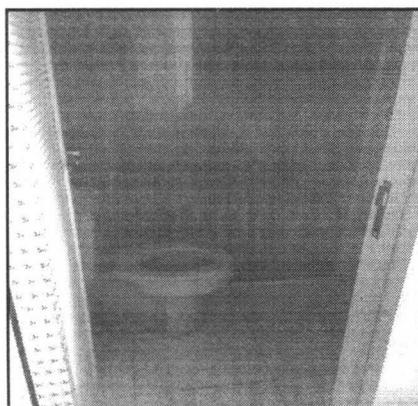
Imagem de banheiro com box de vidro e paredes e piso revestido com cerâmica
